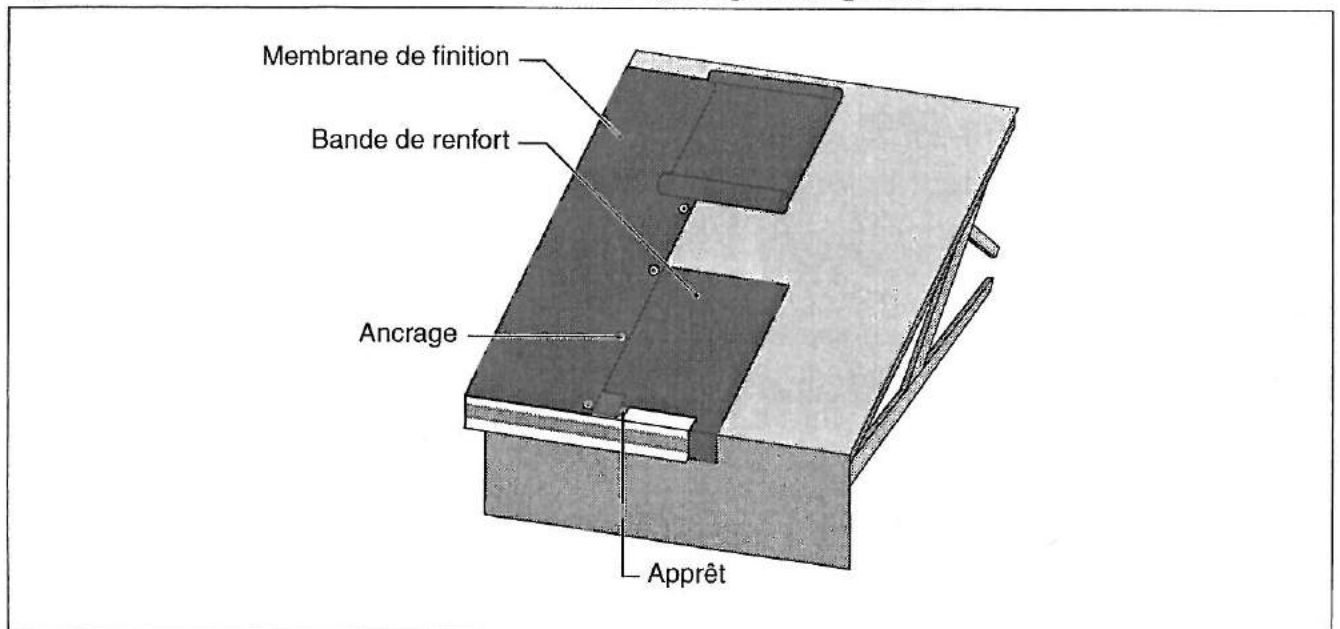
Installation de la membrane sur un toit à forte pente (Soprema)
